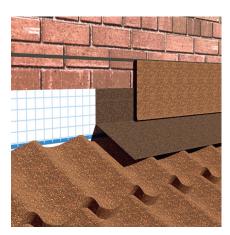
Примыкание ската кровли к стене перпендикулярно к уклону
